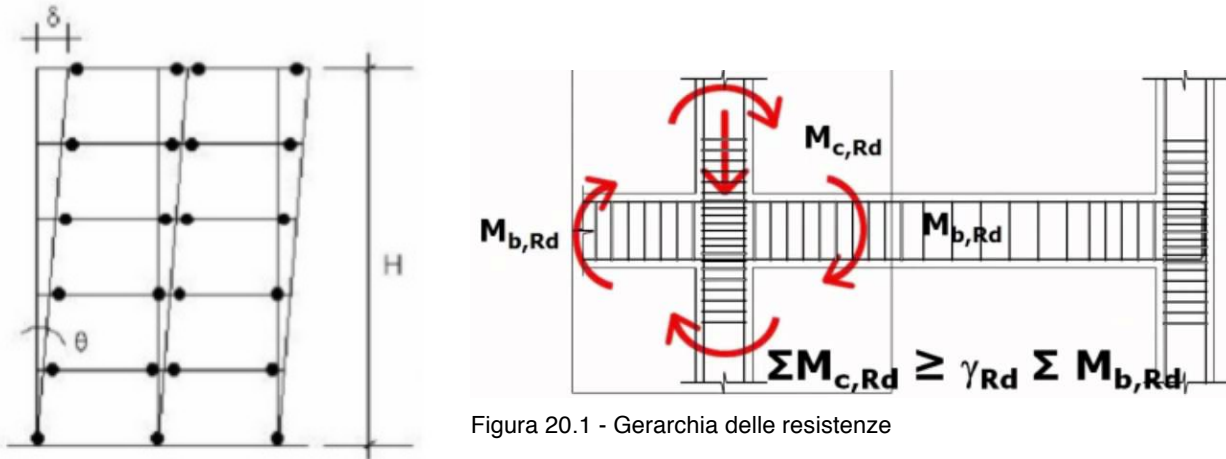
Seconda modalità di collasso - Trave Debole-Pilastro Forte
